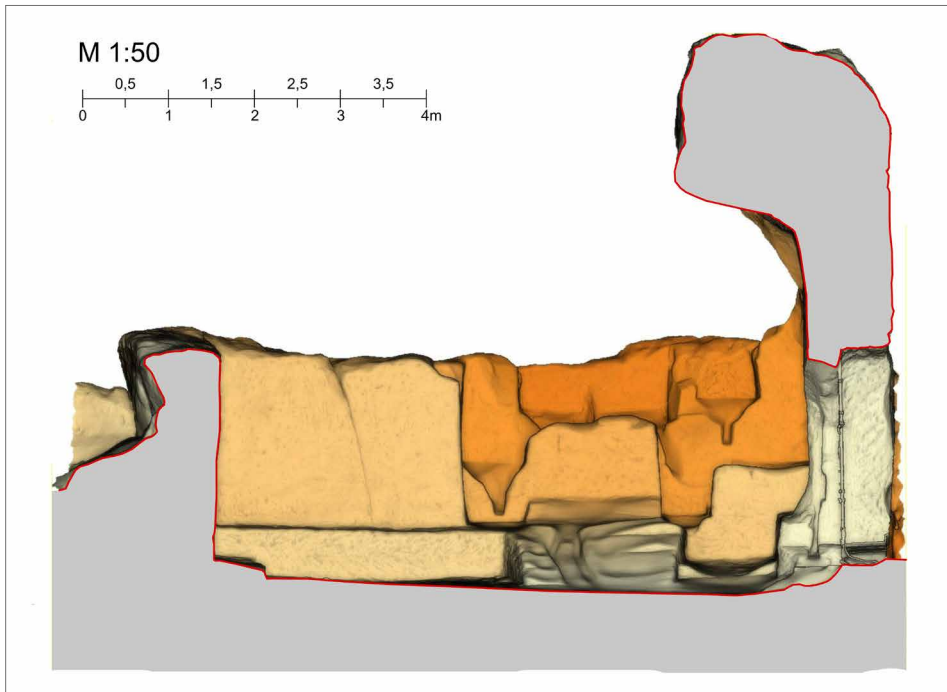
Vermessung der Kapelle, Grundriss mit Kennzeichnung der einzelnen Teile. Auswertung L. Kursová.
